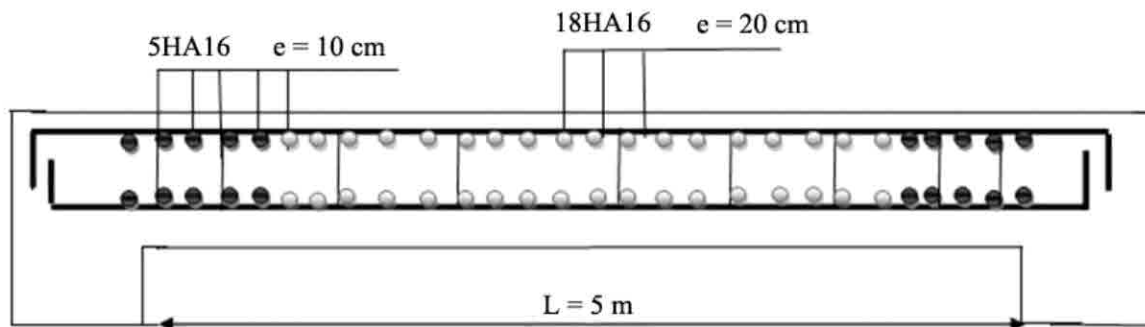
Schéma de ferrailage du voile VY2 (e=35 cm)
